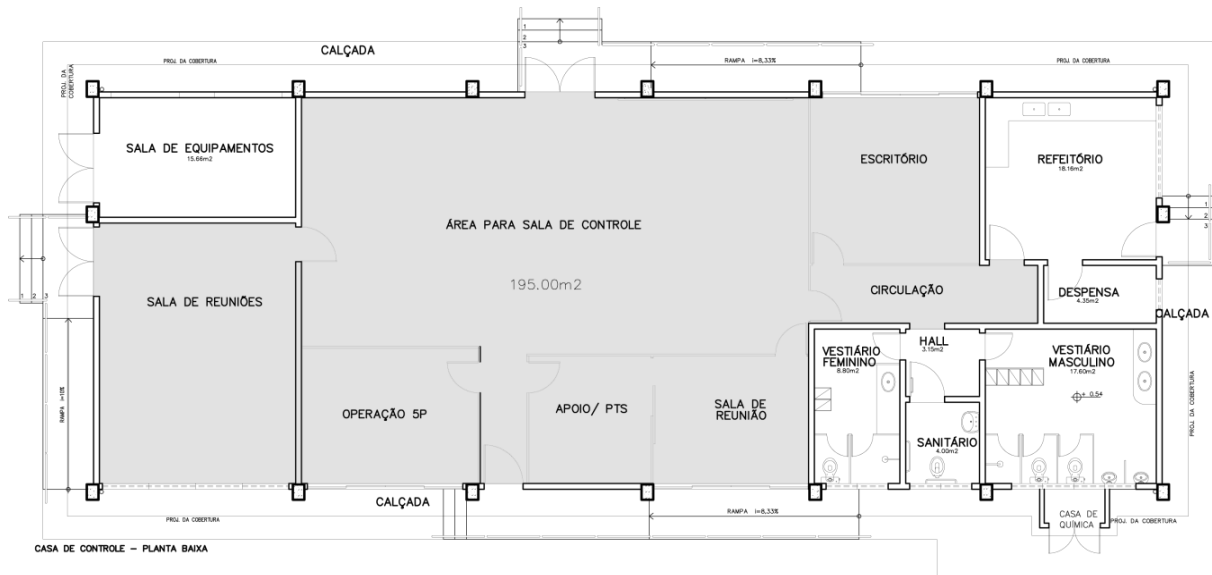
Planta baixa do prédio da 5P, onde seria instalado o CIC
